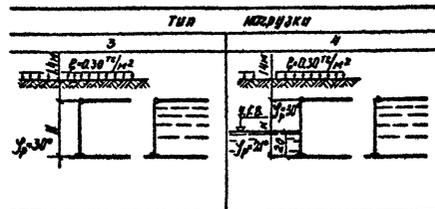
Схемы расчетных нагрузок на балочные стены закрытых сооружений высотой 3,6 и 4,8 м.
